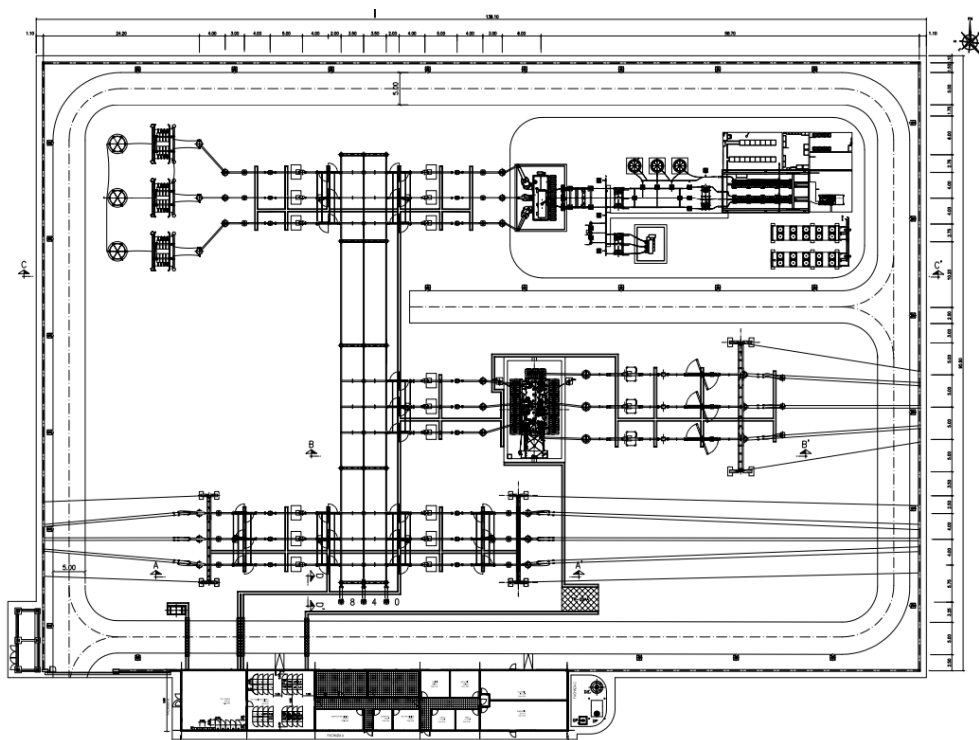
Detalle en planta de la subestación de Promotores y del edificio de la subestación.
